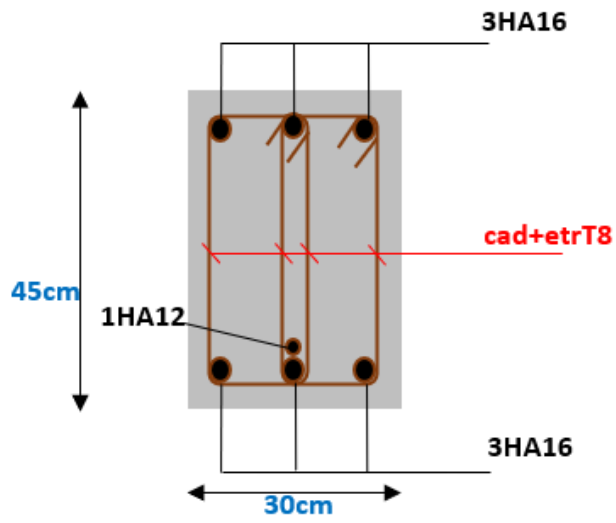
Ferrailage sur travée -Poutre principale-
